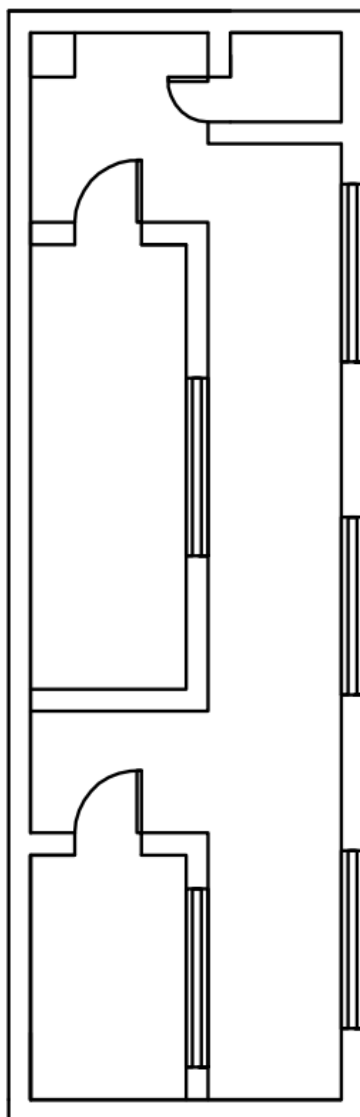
Lay out de la planta alta adaptado al terreno actual.
